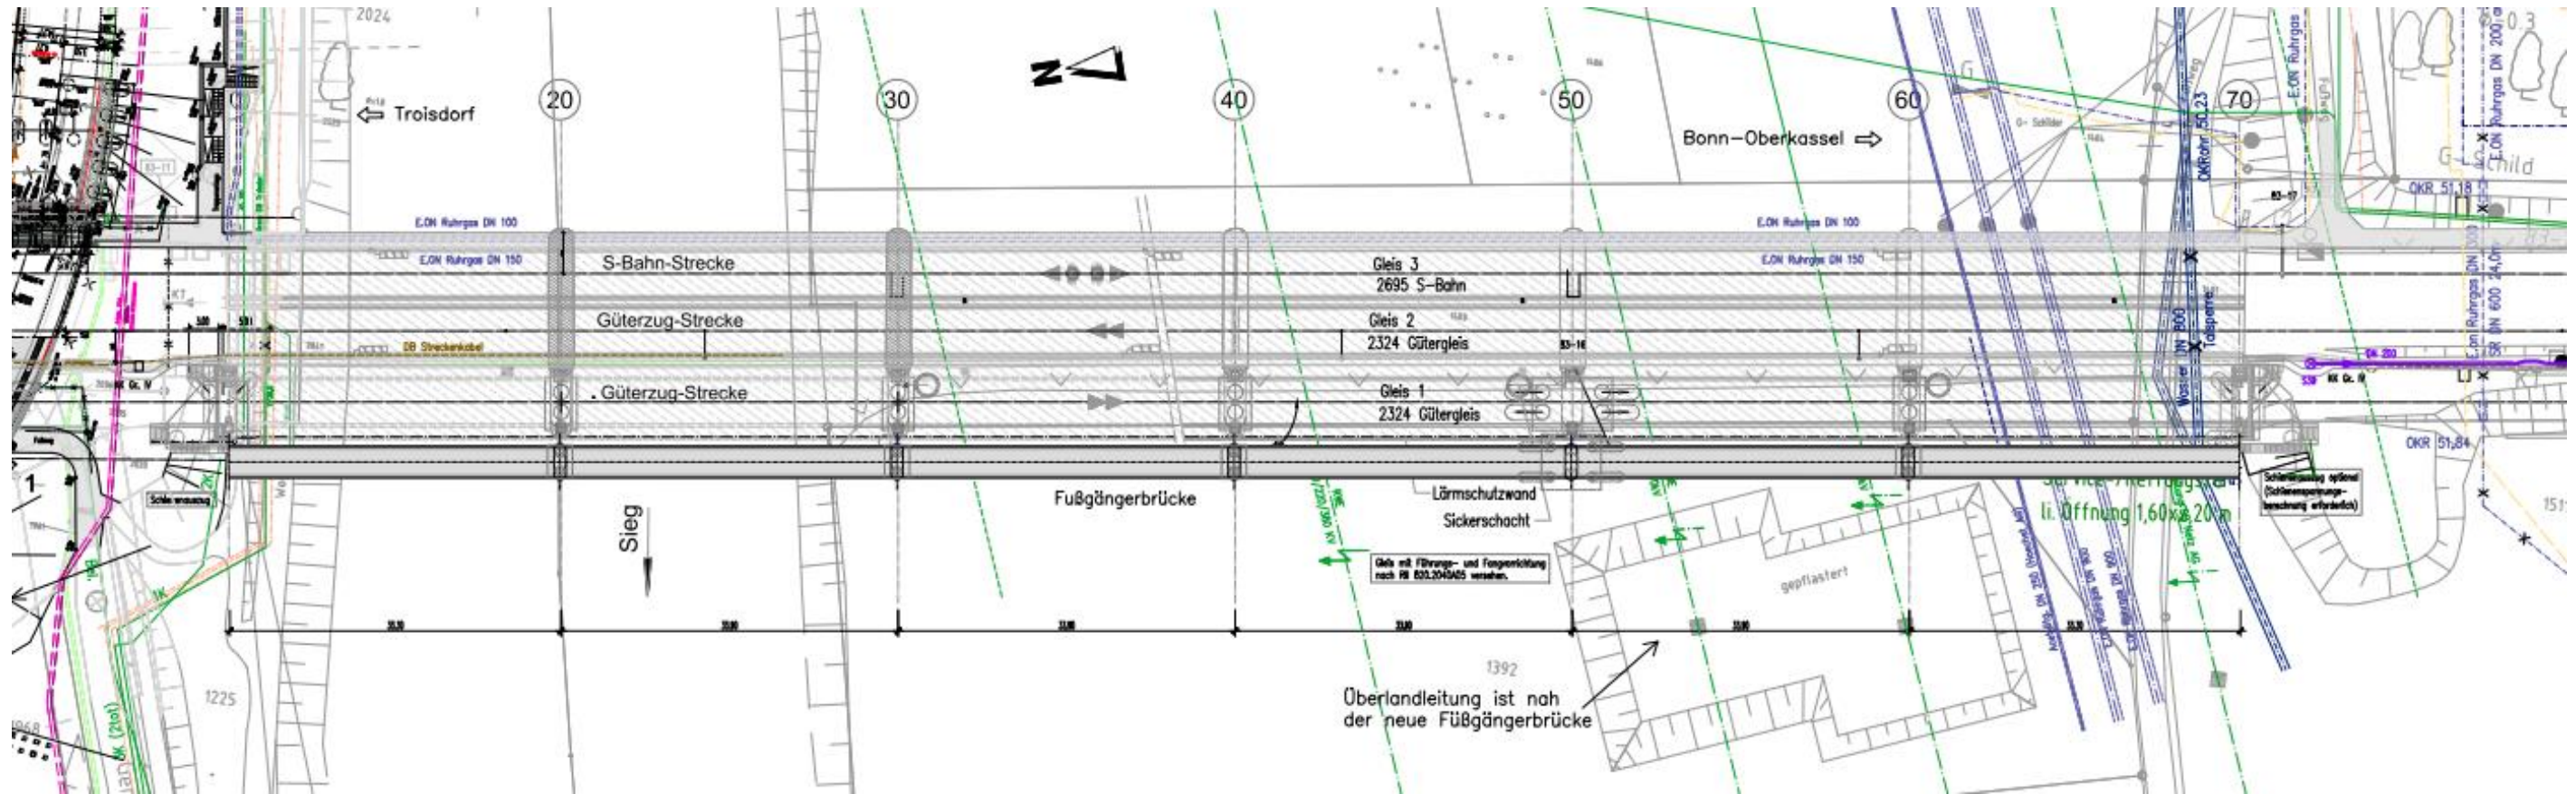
Grundriss_Variante Ia - Westseite
